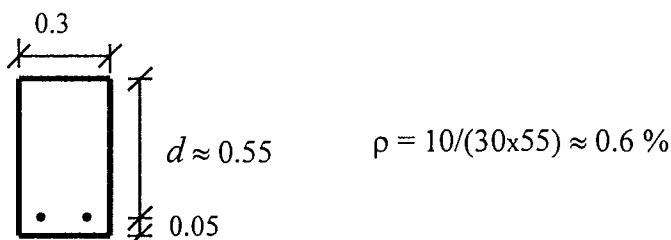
Sección reforzada con 10 cm^2 de acero
